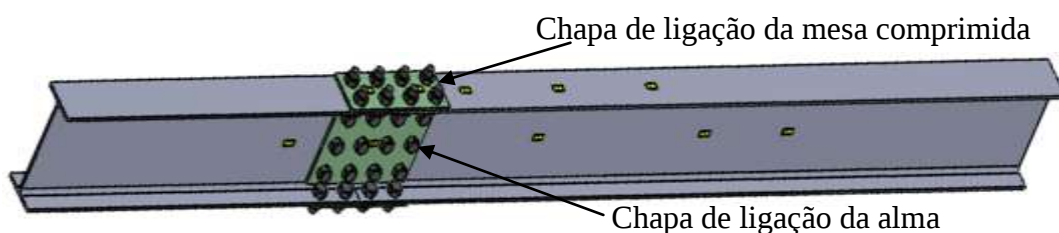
Posicionamento dos extensômetros chapa de ligação da mesa comprimida e alma
